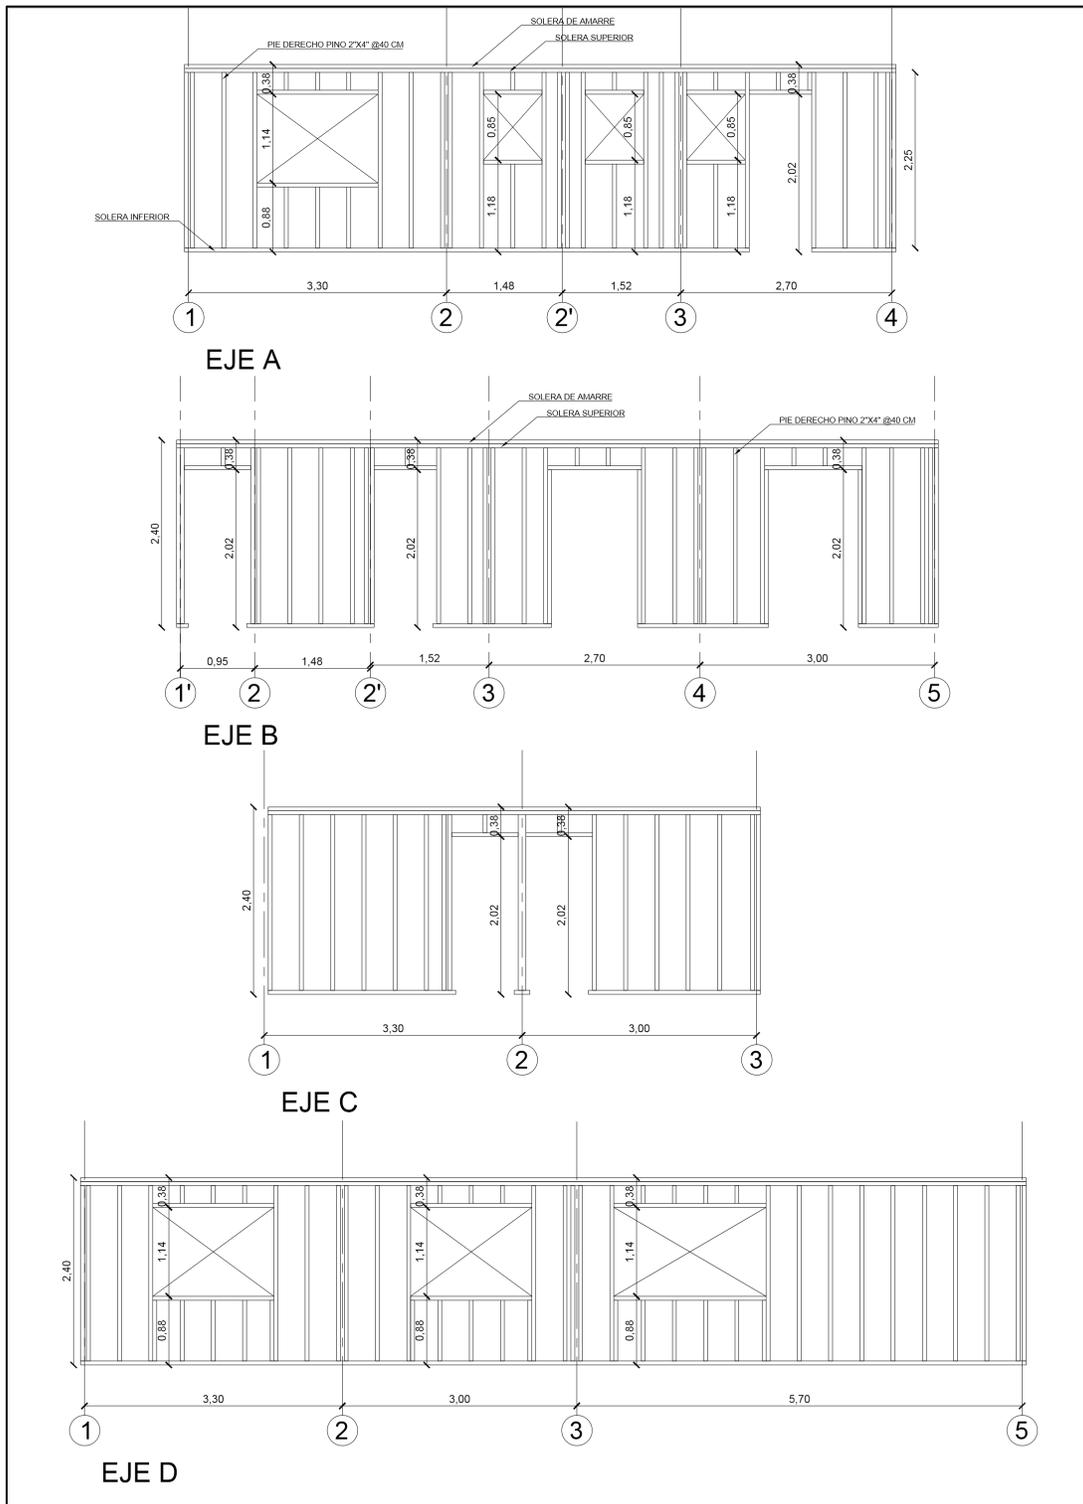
Elevaciones de estructuras modelo entramado de madera 2x4"
